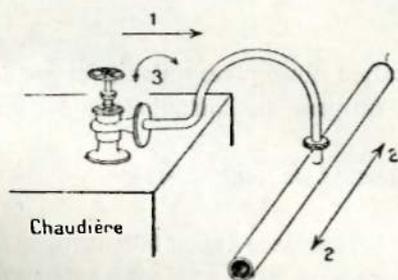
Raccordement entre un point fixe et un collecteur (disposition médiocre).
